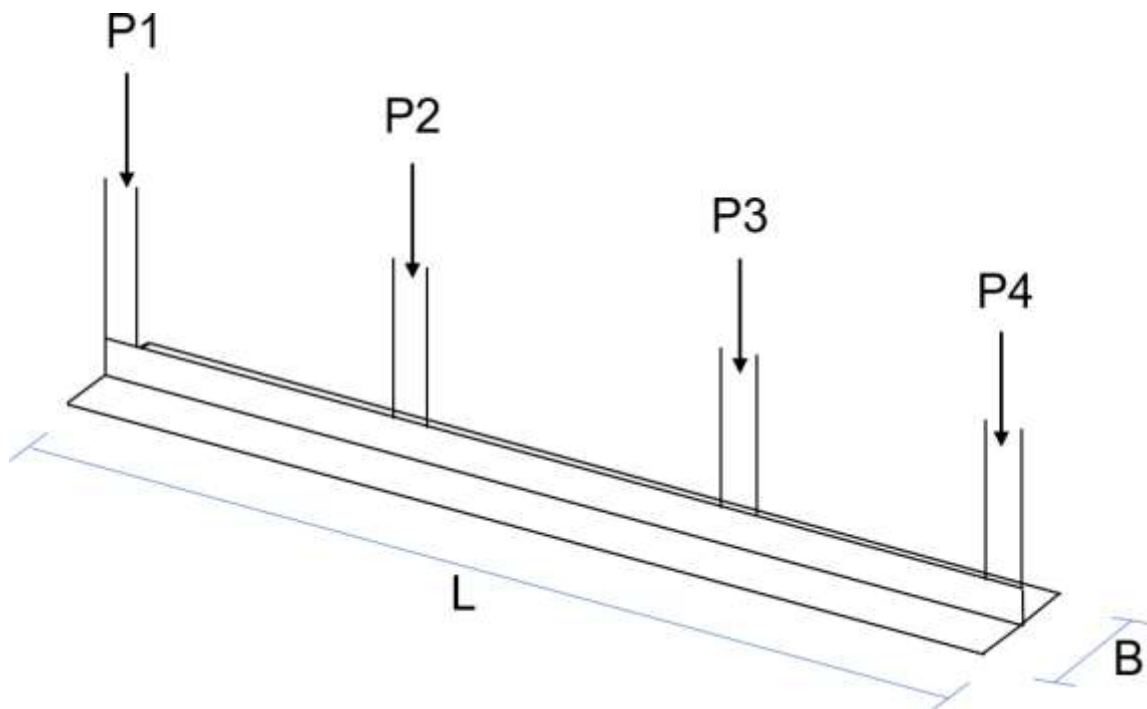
Cargas actuantes sobre la zapata. [Elaboración propia]
